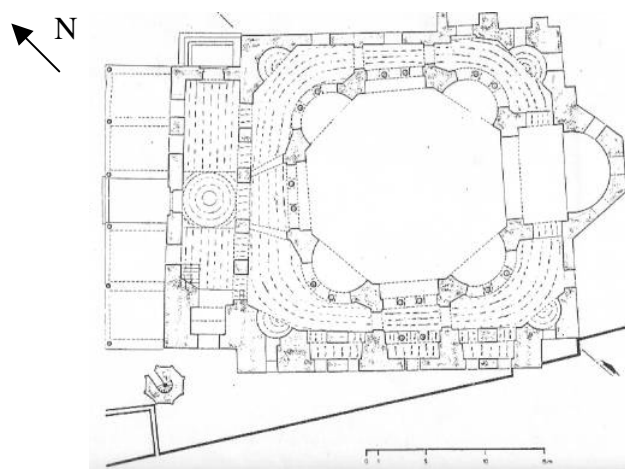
Planta baja utilizada para la construcción del modelo (Arun, 2002)
